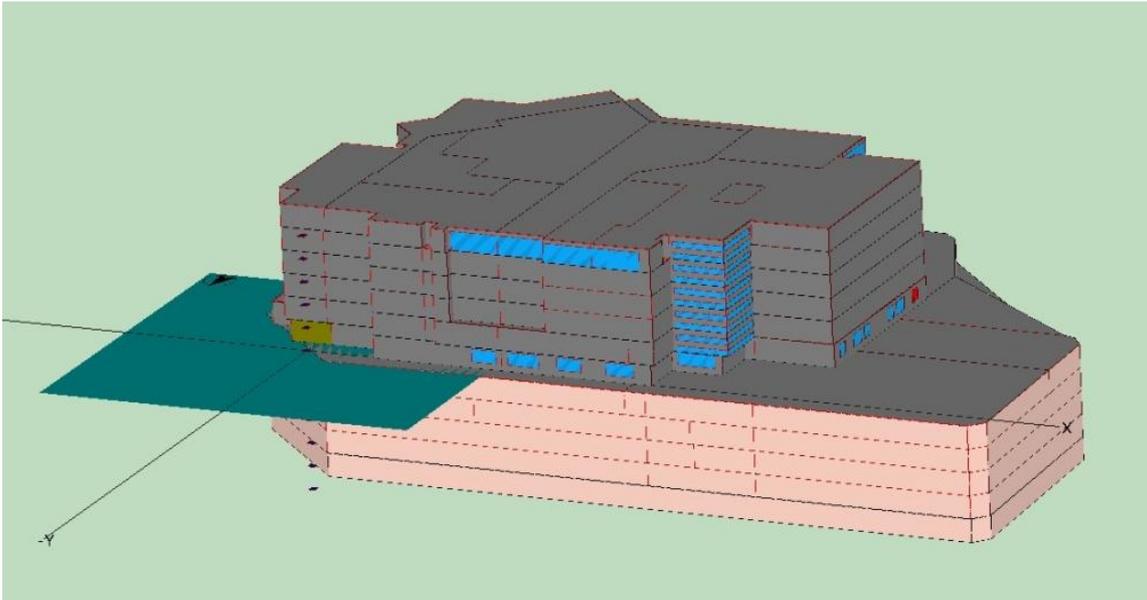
Vista tridimensional de ECI Albacete (fachada norte)
